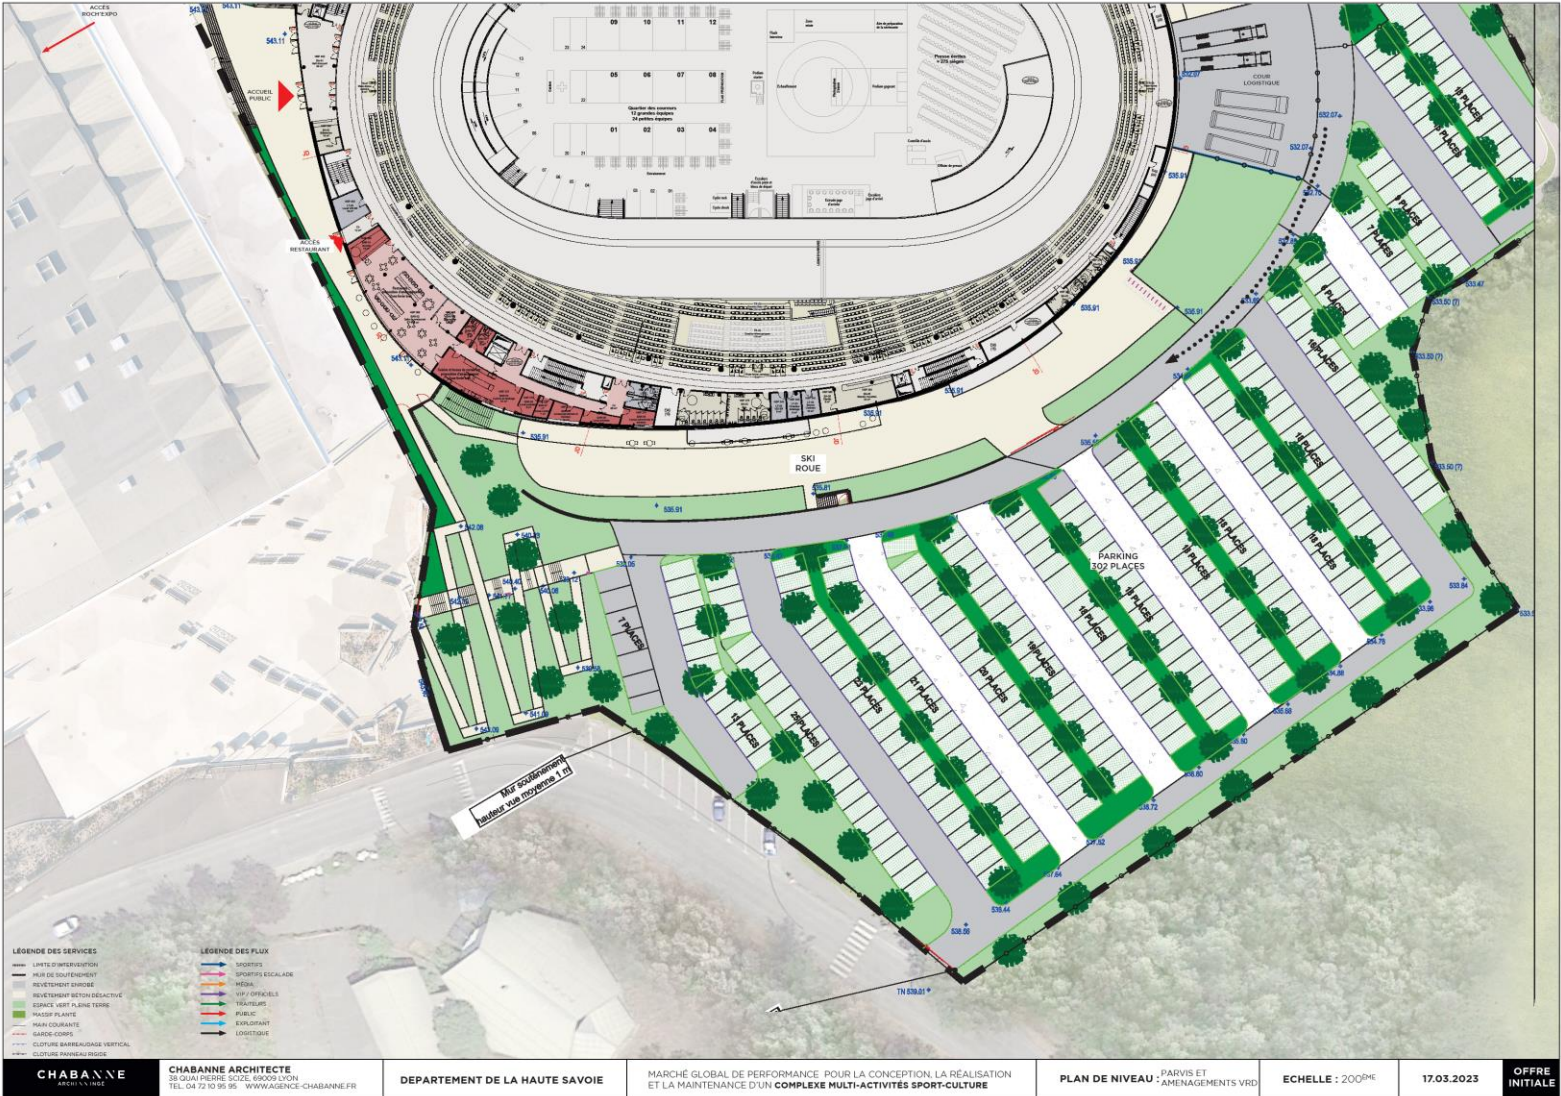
Plan VRD 2 (Source : Chabanne Architecture)
